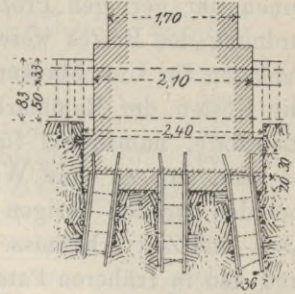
u. 186. *Betonpfahlrost des Mittelpfeilers.
